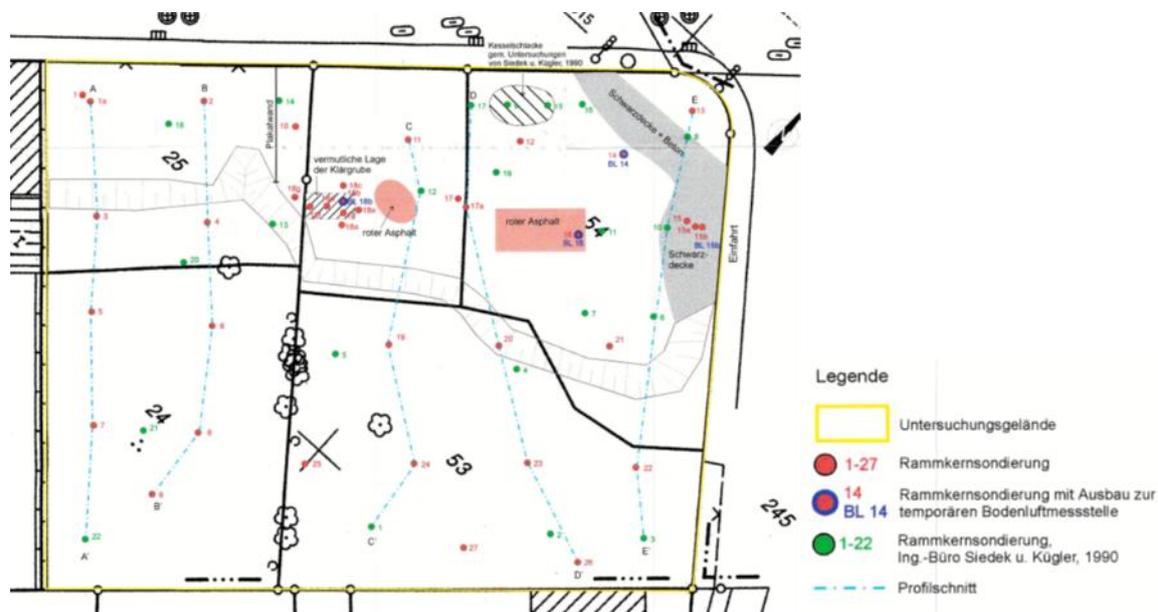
Auszug aus dem Lageplan der Sondieransatzpunkte¹⁵
